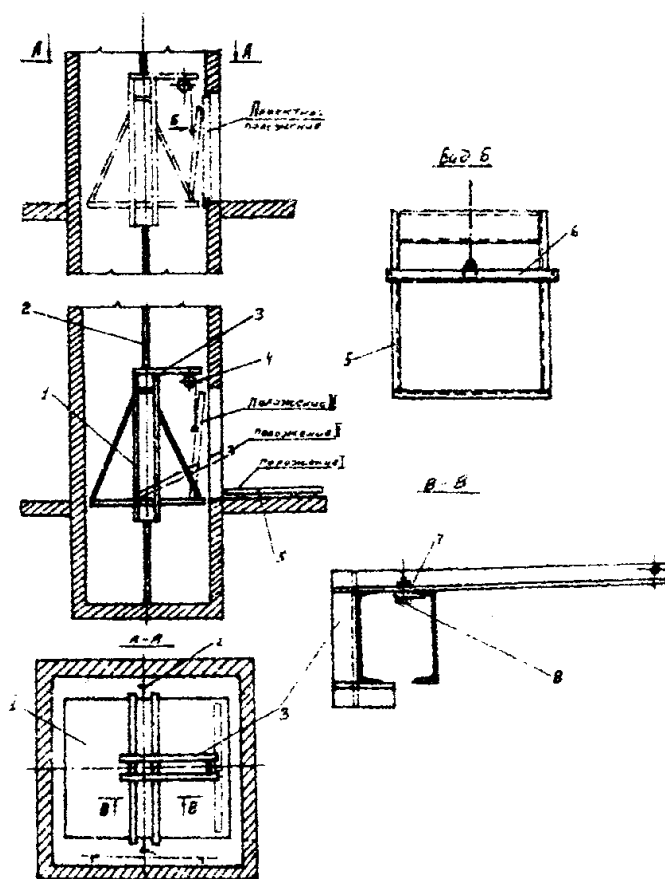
Монтаж дверей шахты грузовых лифтов с использованием кабины:
